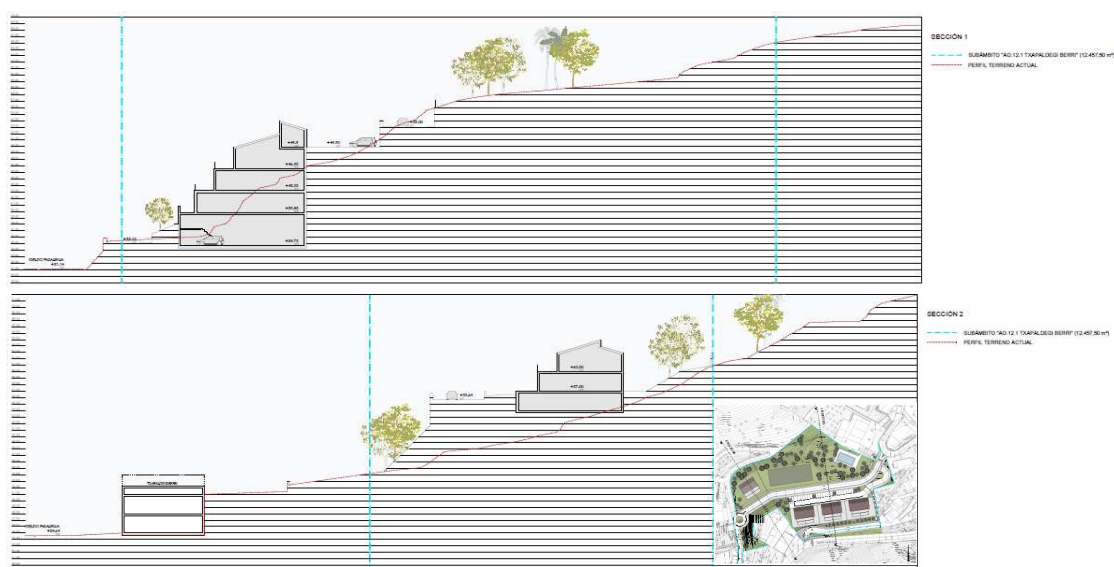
Secciones transversales y planta guía para las propuestas del Plan Especial.
